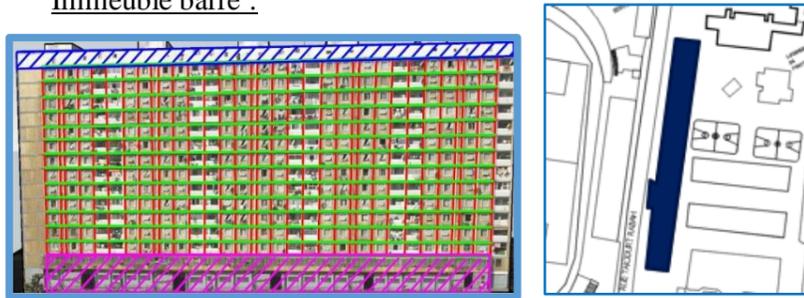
Vue en plan et schématisation d'une façade de l'immeuble barre
